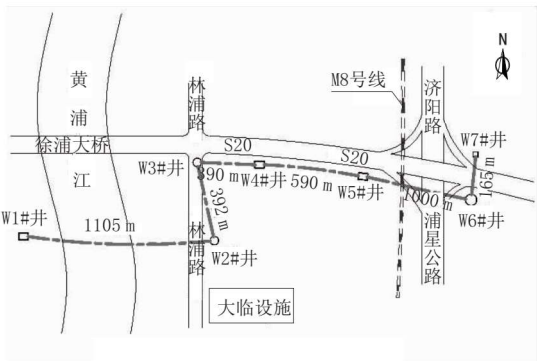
白龙港南线输送干线 SST1.2 标施工平面图
